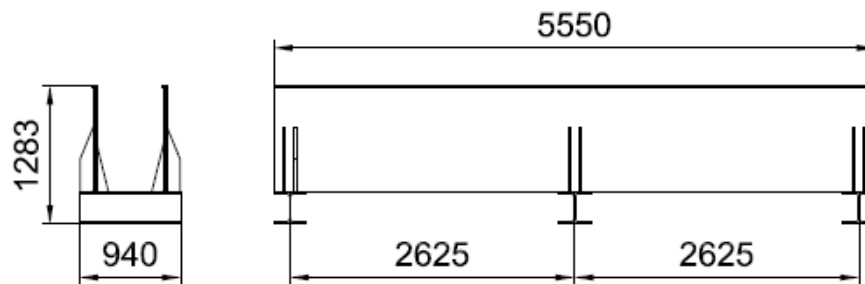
BG2; Position 1, Vorderansicht und Seitenansicht
